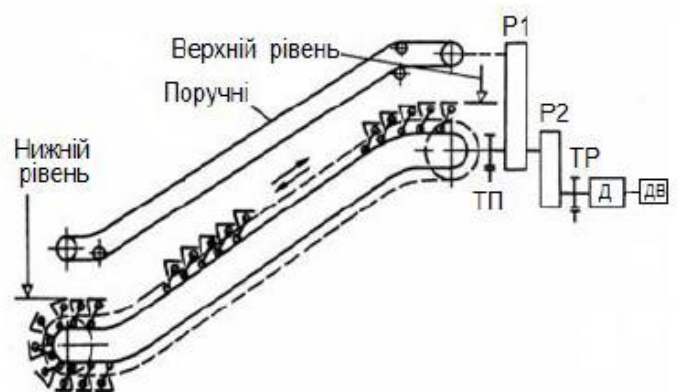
Ескалатор: Р1 і Р2 – редуктори; Д – приводний двигун; ТП і ТР – привод
